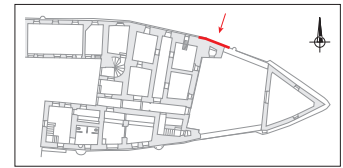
Tour d'escalier - Mur SUD (UM6) - Relevé du bâti - Éch. 1/100.
